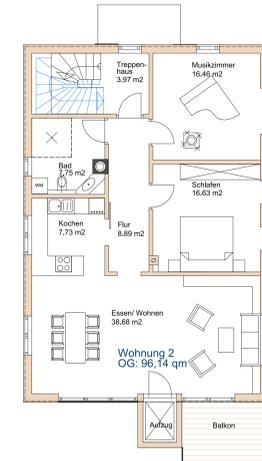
Grundriss Dachgeschoss (Neubau)
